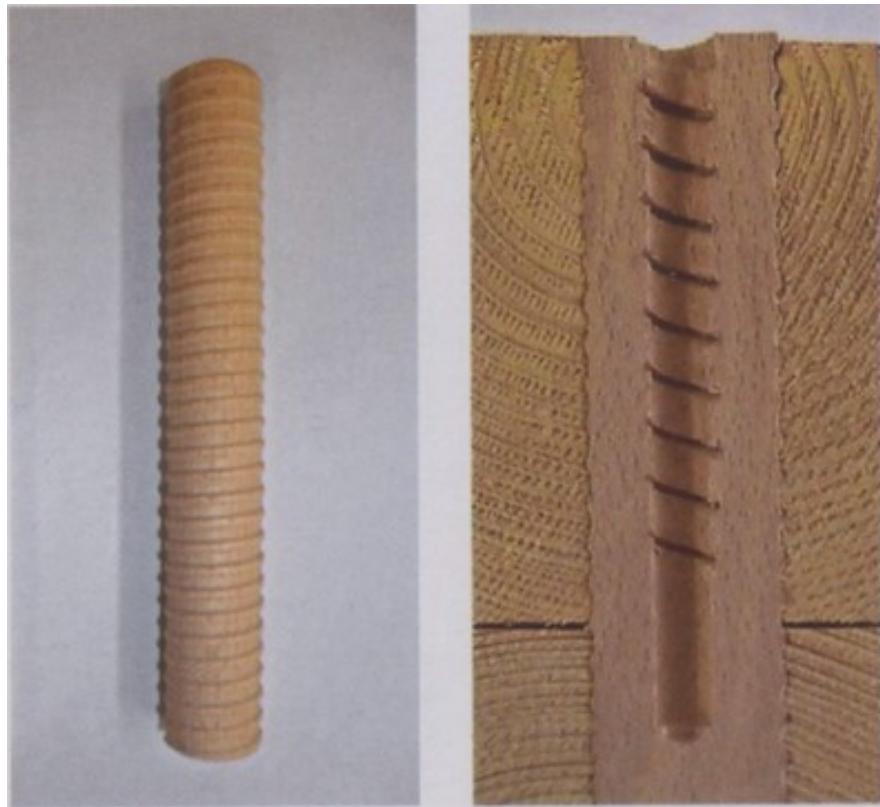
可拆卸性-用于刚性施工方法的紧固件: 木螺钉和木销钉 ©DETAIL
